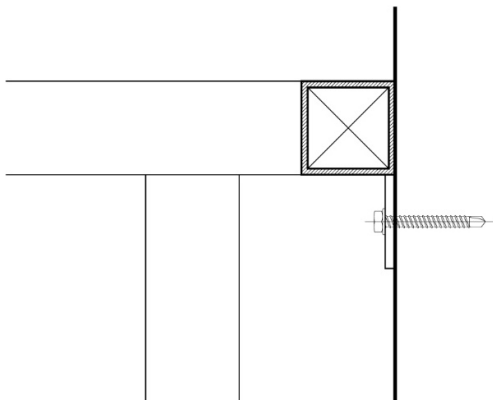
, estructura de hierro para mesadas de granito, las que lleven instalación sanitaria deben fijarse al muro por intermedio de platinas
